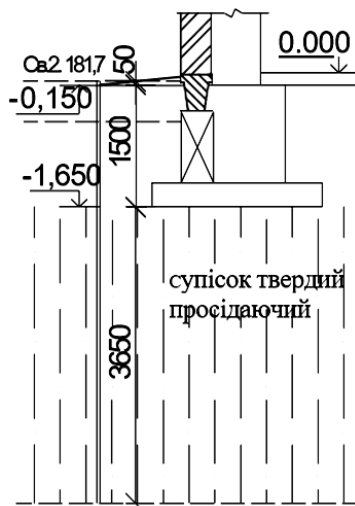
Вертикальна прив'язка фундаменту на перетині осей А і 3
